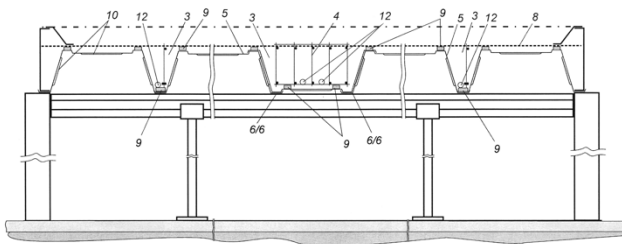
Поперечный разрез полотна несъемной опалубки перекрытия здания, собранного из универсальных модульных опалубочных элементов [4], где: 1 – наружная поверхность; 2 – рабочая поверхность; 3 – кессонообразователи; 4 – рабочие арматурные каркасы; 5 – основание-полка; 6 – отбортовка; 9 – дистансеры; 10 – поперечные ребра жёсткости; 12 – канаты.
